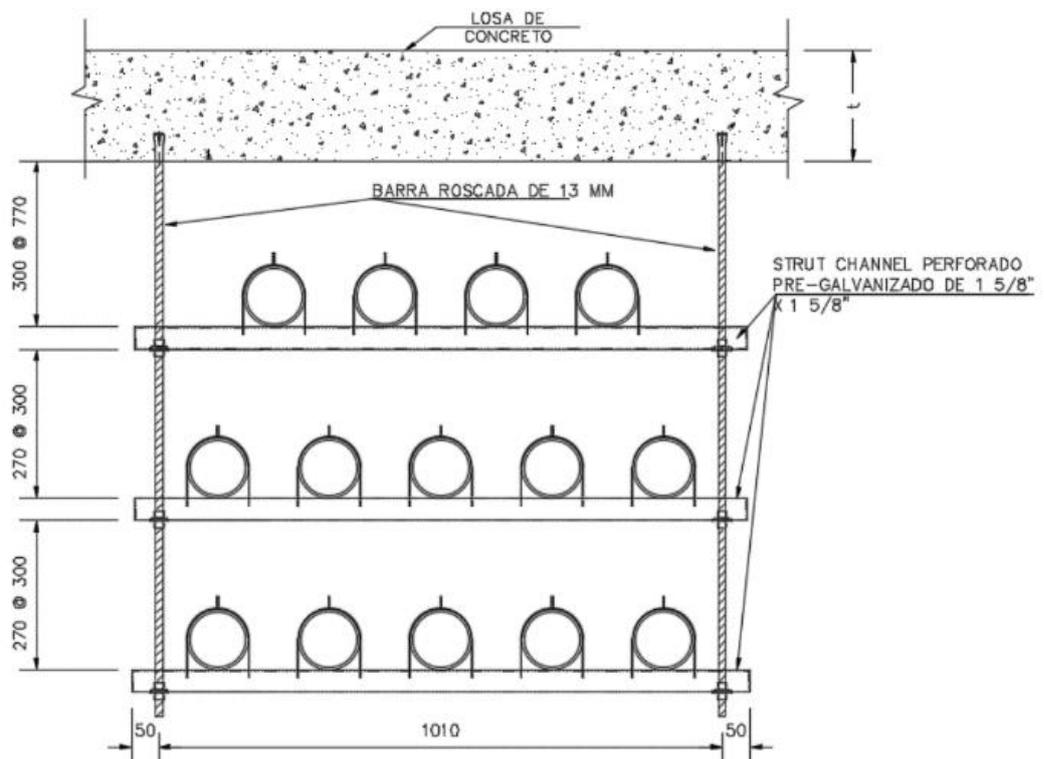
Arreglo máximo de tuberías suspendidas en losa en Baja Tensión
